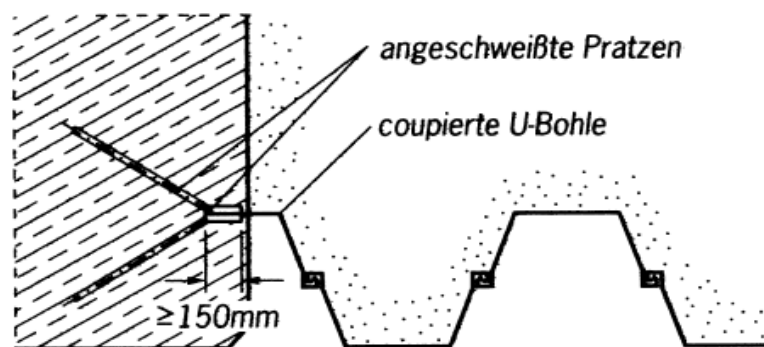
Anschluss einer Spundbohle an ein neu zu errichtendes Betonbauwerk mittels einer einbetonierten U-Bohle⁹²
